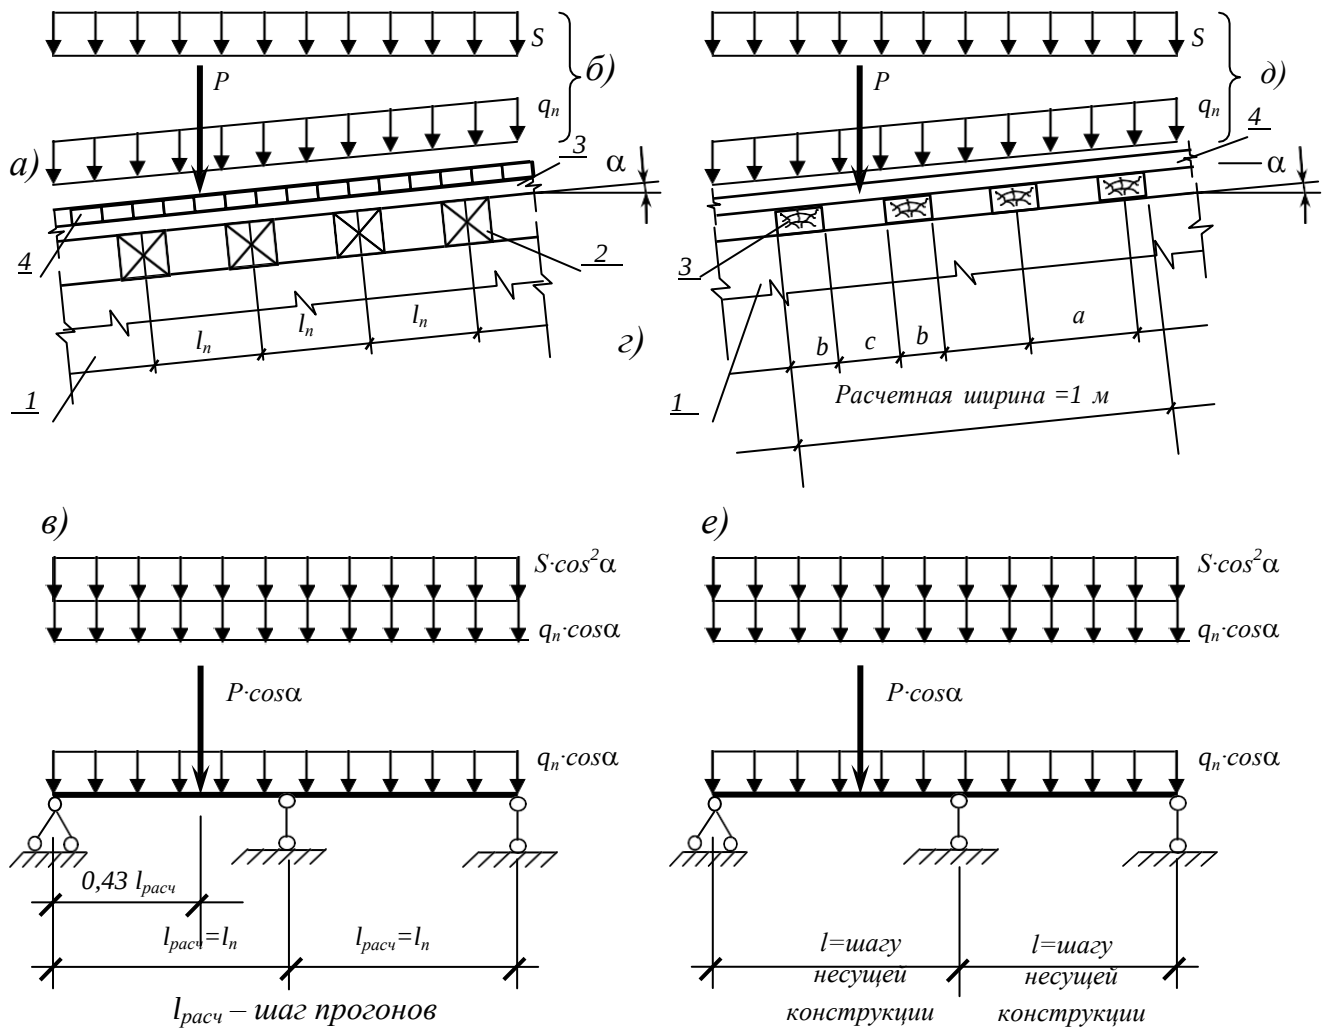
Типы настилов: а – продольный настил; б – схема приложения нагрузок; в – расчетная схема; г – поперечный настил; д – схеме приложения нагрузок; е – расчетная схема; (1 – верхний пояс несущей конструкции; 2 – прогон; 3 – рабочий настил; 4 – защитный настил)
